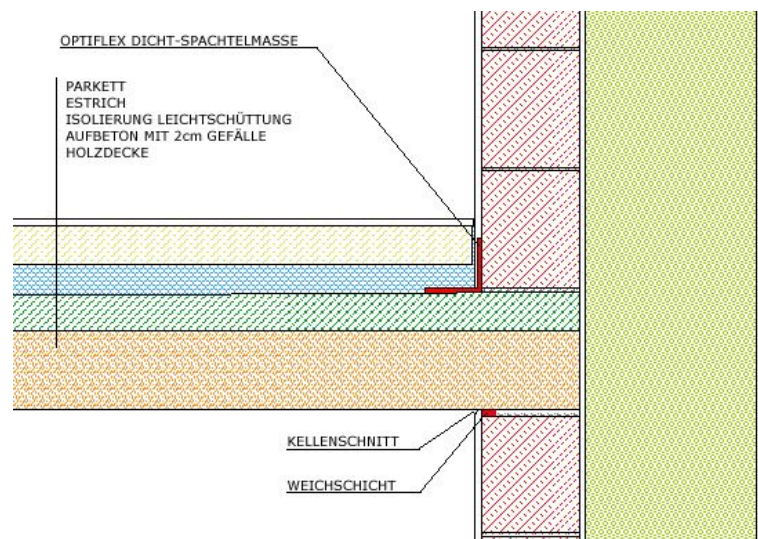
Baudetail Deckenanschluss Holzverbunddecke / Lehmziegelwand
